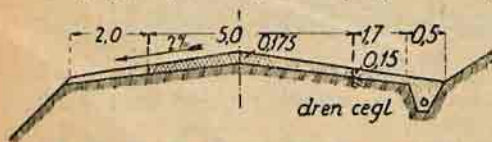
Przekrój amerykańskiej drogi betonowej.
